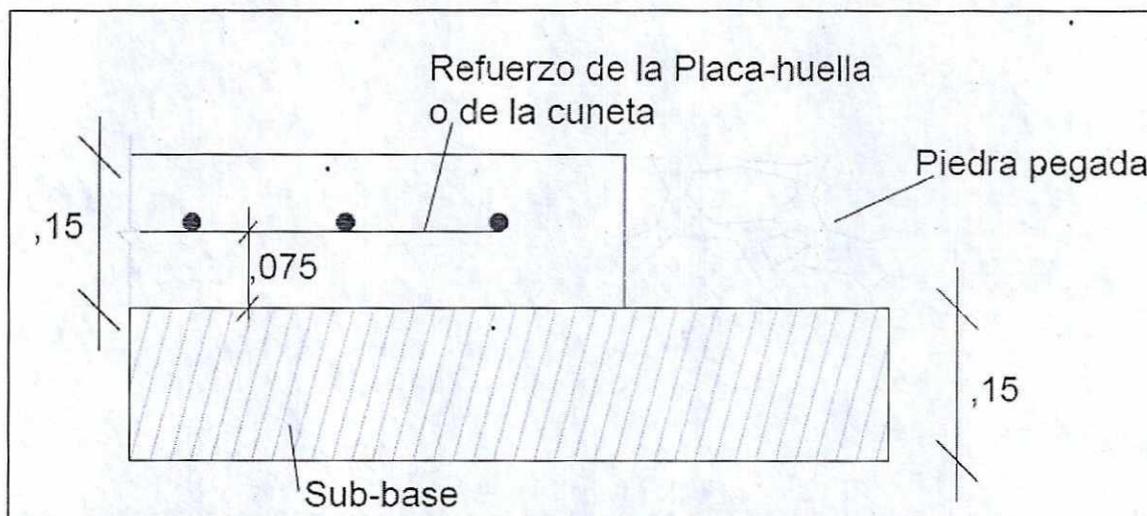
Junta de longitudinal de construcción entre la placa huella, riostra o berma cuneta y la piedra pegada.
